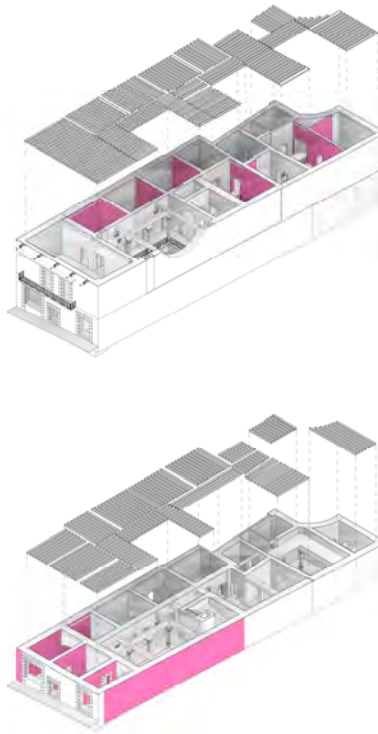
Representación tridimensional de la planta baja y la planta alta en donde se observa sombreados los muros que presentan afectaciones y en los cuales se hizo monitoreo de grietas. CAMEM.
